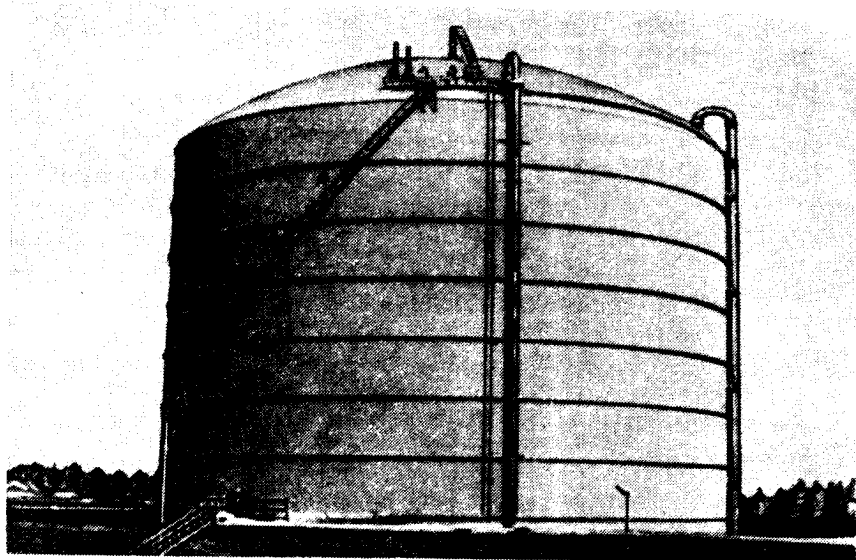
Наземний циліндричний ізотермічний резервуар
